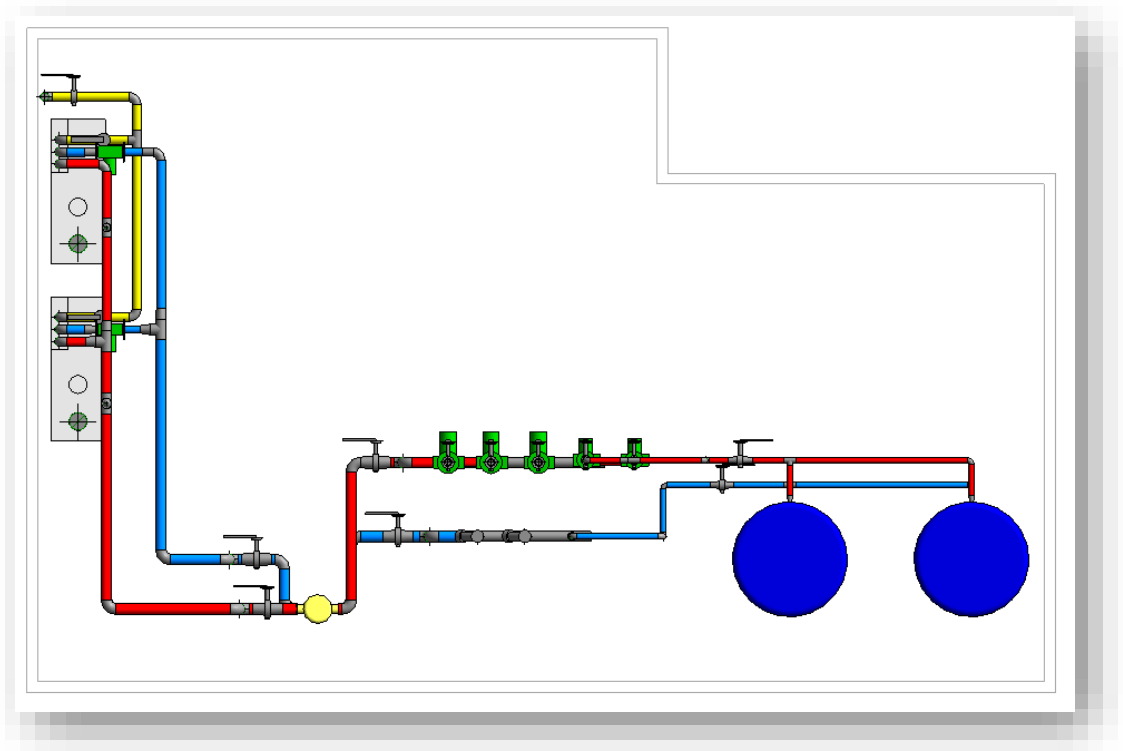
Planta sala de calderas bloque de viviendas en Avenida Salamanca
